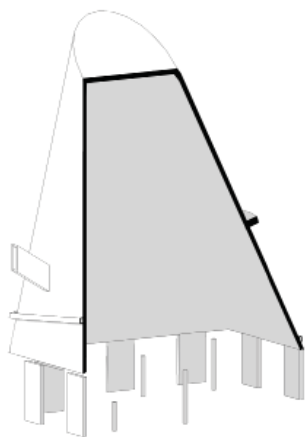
Estructura de la cáscara apoyada en muros pantalla. Fuente: MCHS.
